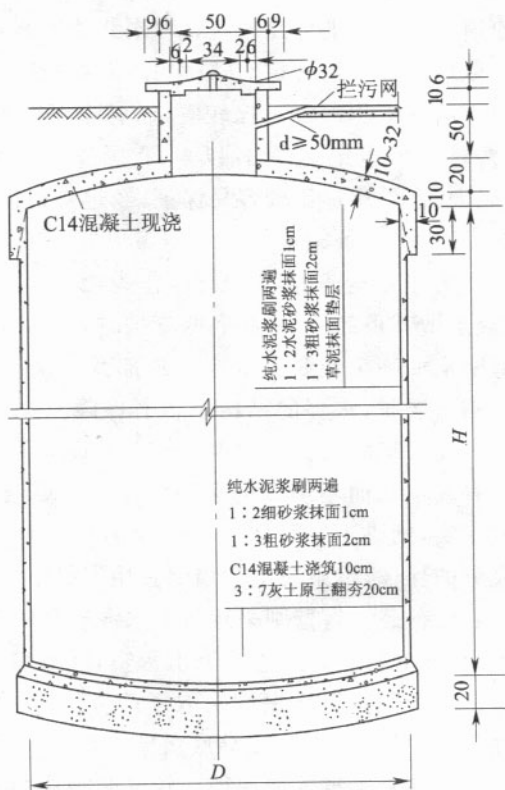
混凝土顶拱水泥砂浆薄壁水窖剖面(单位:cm)
